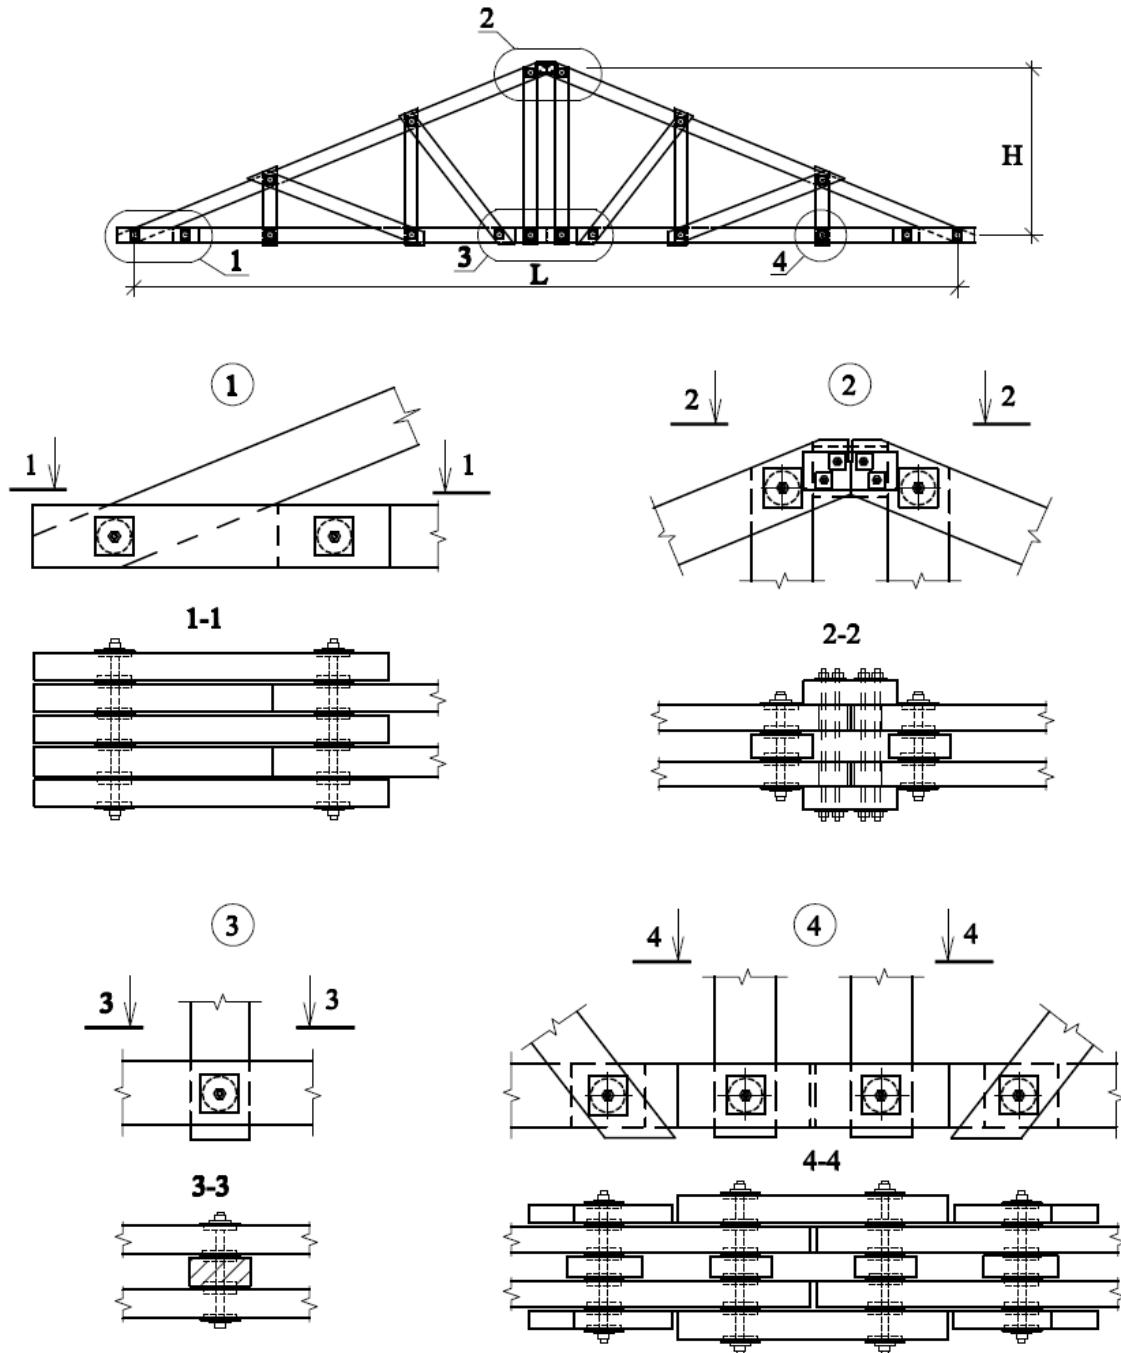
Конструктивное решение треугольной 6-панельной фермы и ее узлов:
